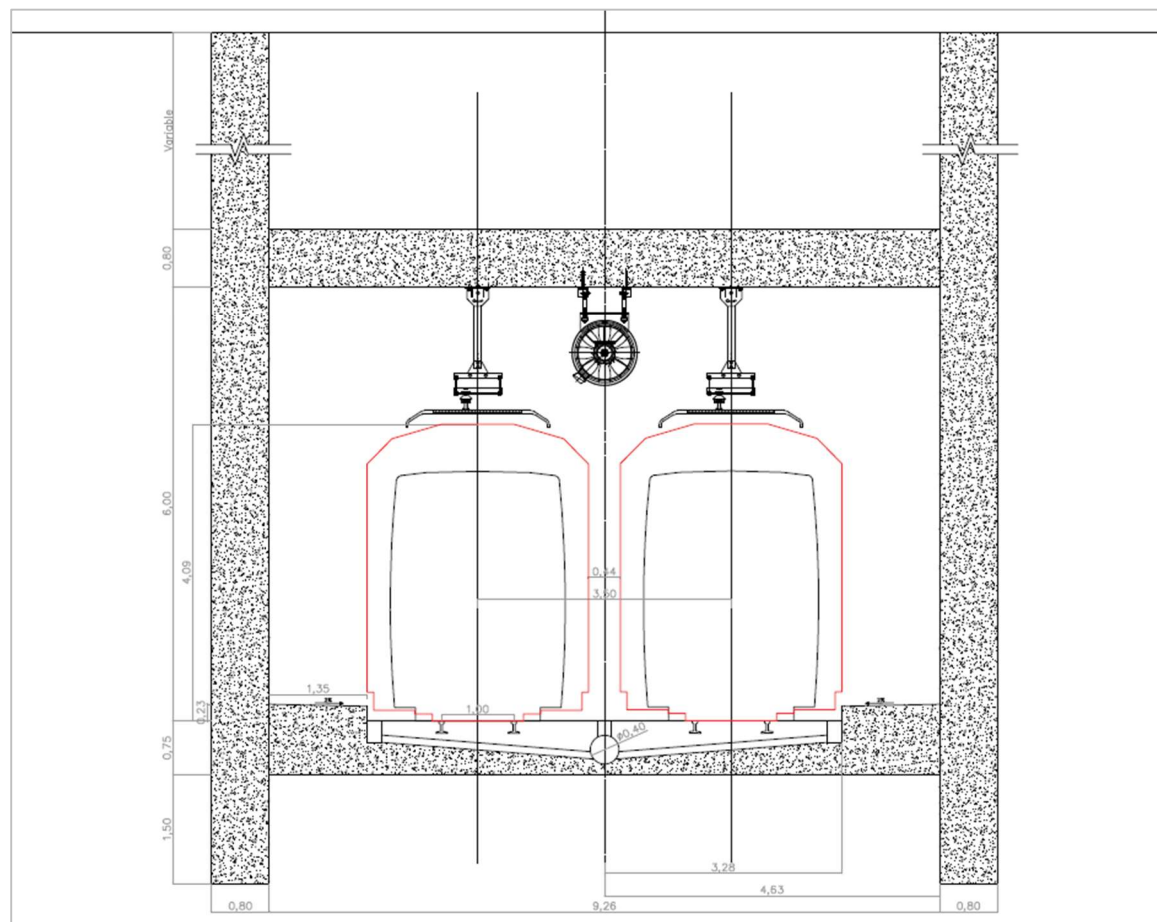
Sección transversal – Alternativa 2. (Fuente: Elaboración propia)
